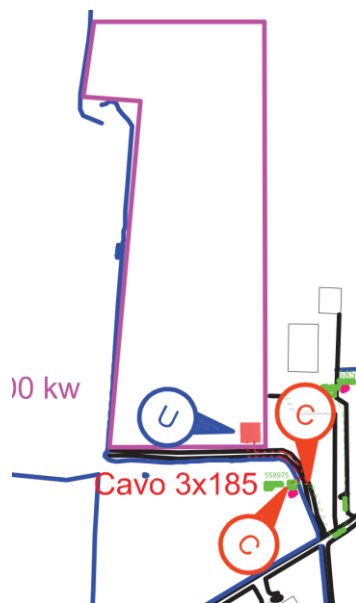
planimetria della soluzione di connessione (dal preventivo di E-Distribuzione)
